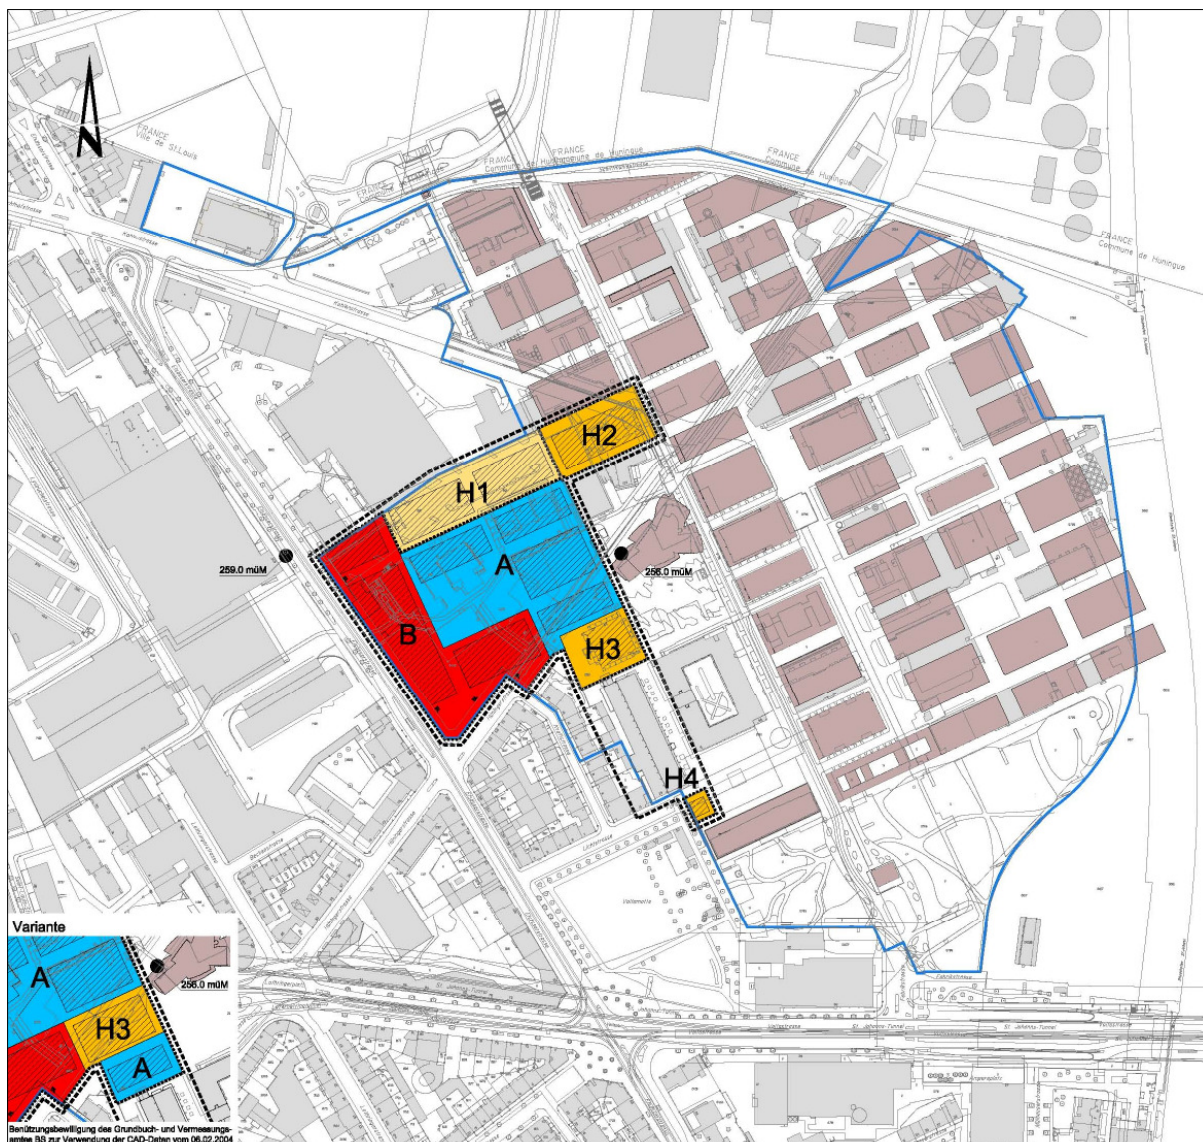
Bebauungsplan 13'573 (kein Massstab, Plan genordet)
